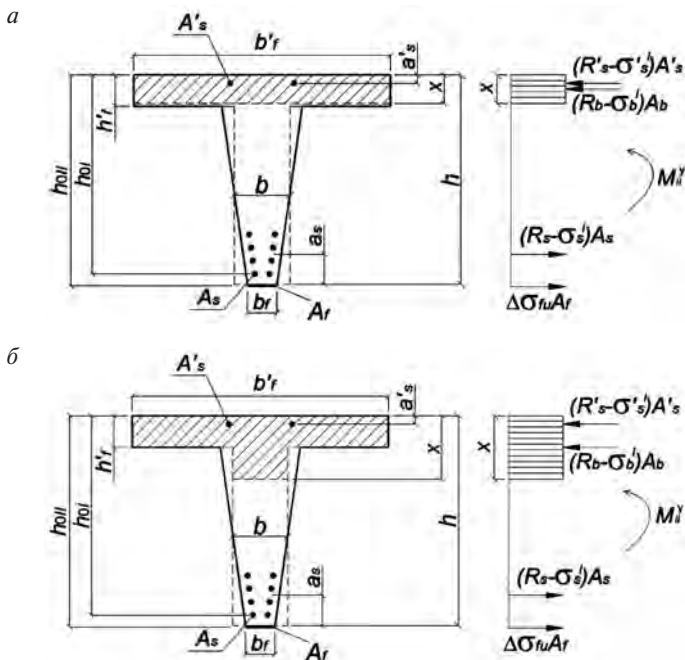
Расположение внутренних усилий и форма эпюры напряжений в сжатой зоне бетона в предельном состоянии для таврового сечения, перпендикулярного к продольной оси усиленного балочного железобетонного элемента композиционным материалом, с учетом наличия величин нормальных напряжений в бетоне и металлической арматуре от действия первой части расчетных постоянных и прочих нагрузок:
